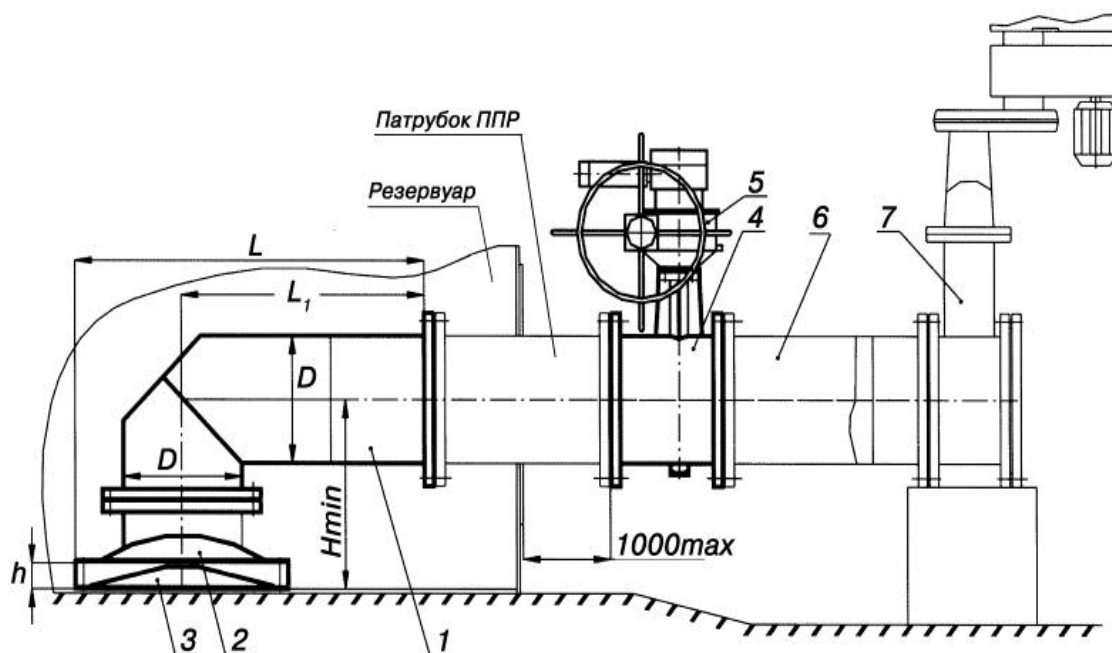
Общий вид приёмо-раздаточного устройства
